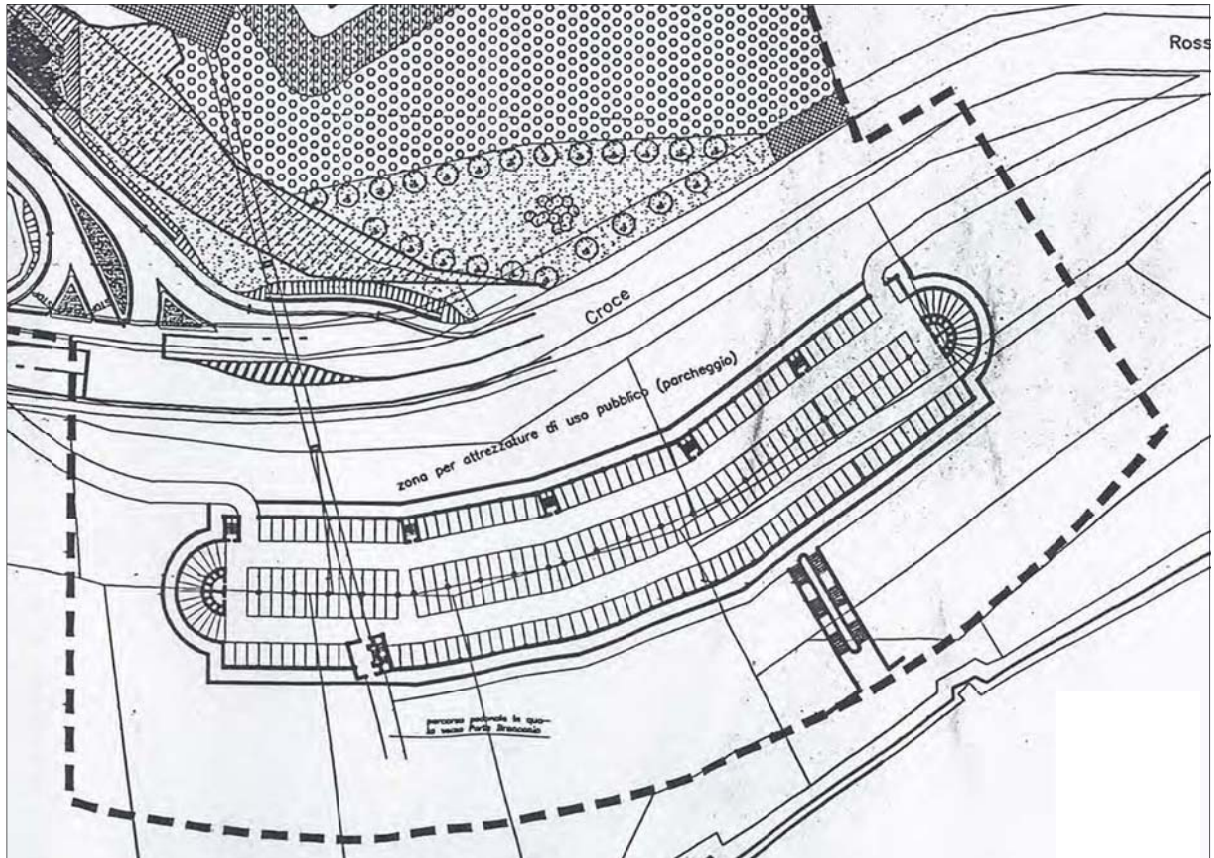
variante al PRG con individuazione di un parcheggio ad uso pubblico
